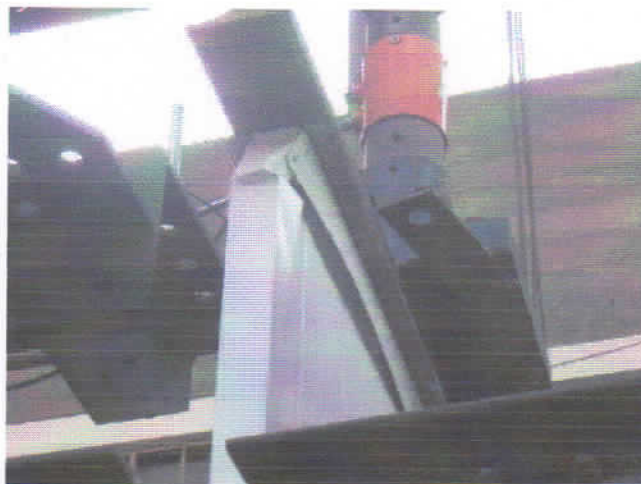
Aplastamiento en la esquina superior del panel muro M-1.
